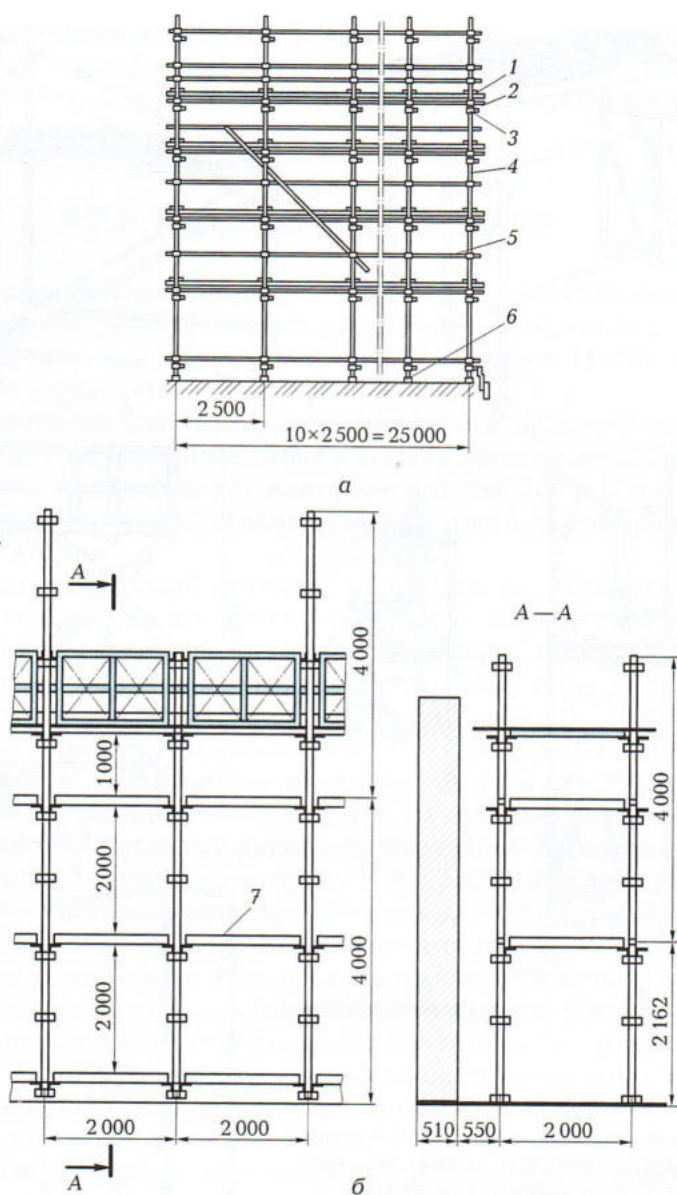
Строительные леса на хомутах (а) и безболтовые (б):
